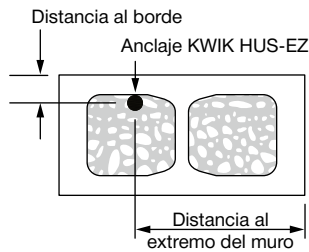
Ubicaciones aceptables (áreas sombreadas) para anclajes Kwik HUS-EZ en mampostería de concreto rellena con grout
